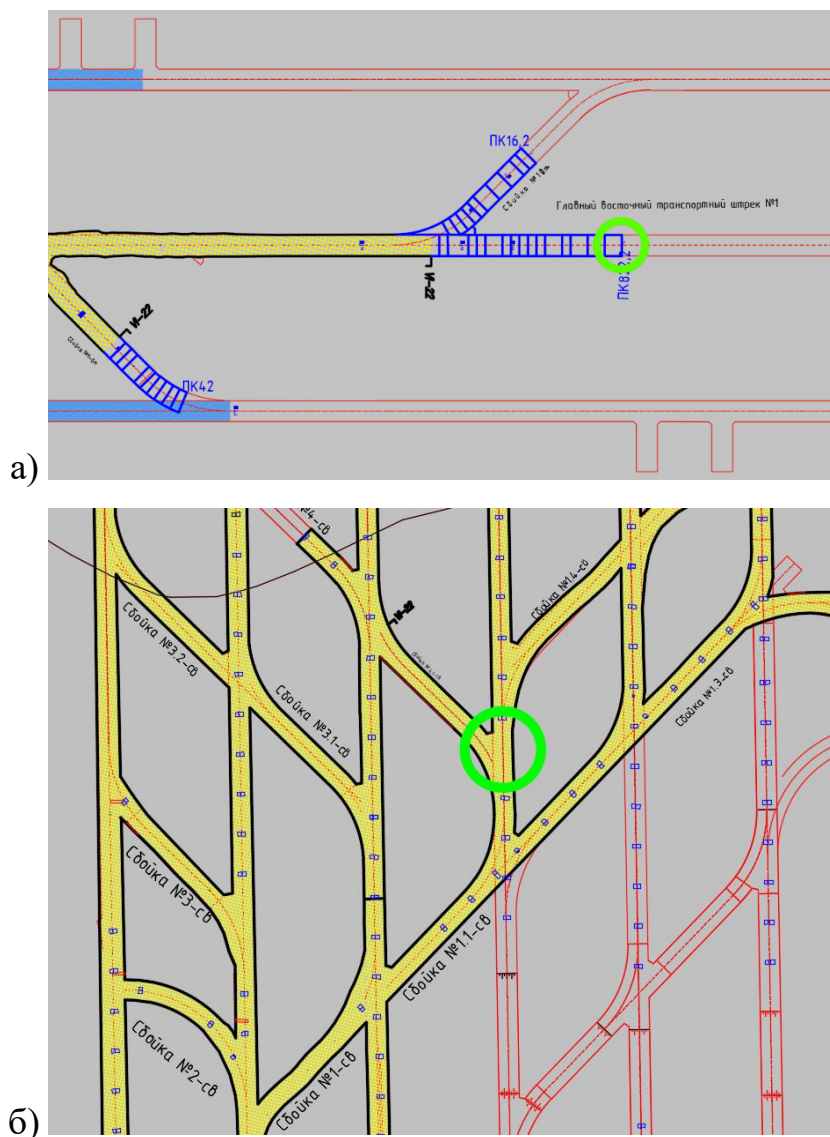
План выработок с указанием мест проведения испытаний анкерной крепи: а – в соляных породах, б – в ангидрит-доломитах
